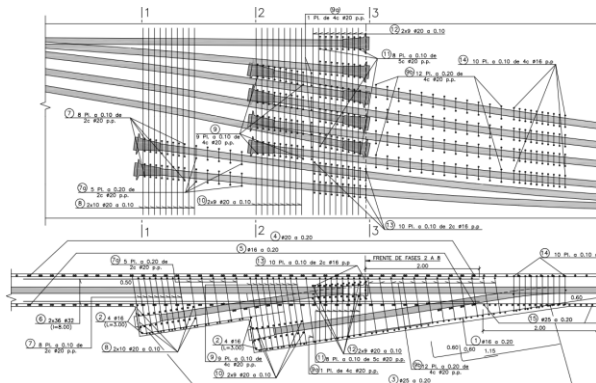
Alzado y planta del frente de fase del Viaducto sobre Rambla Almocáizar [4].
